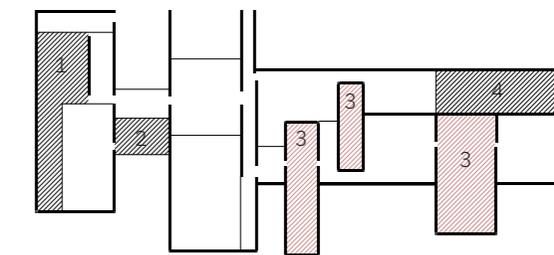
Schematische Grundrisse (EG) Kulturzentren/Museen, 1:1500
